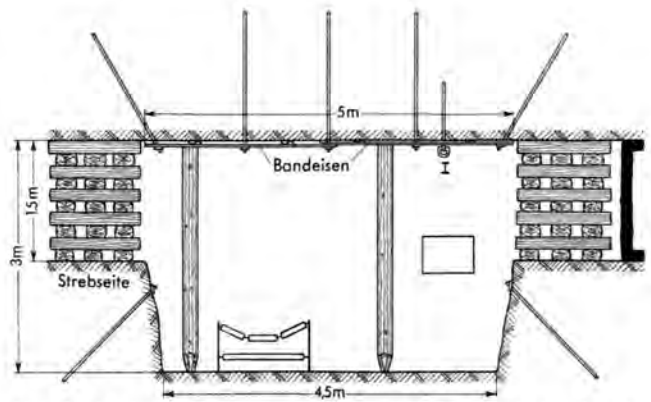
Geplante Anordnung des Streckenausbaus nach dem Durchgang des Strebs.
